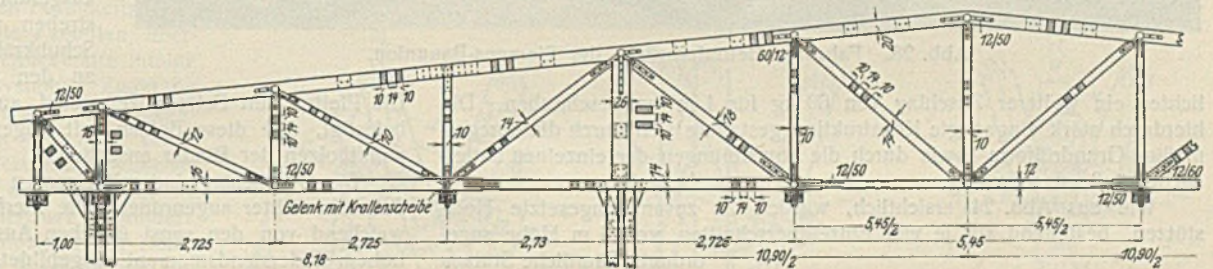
Kajeschuppen Bremen. Unterzug 5.
